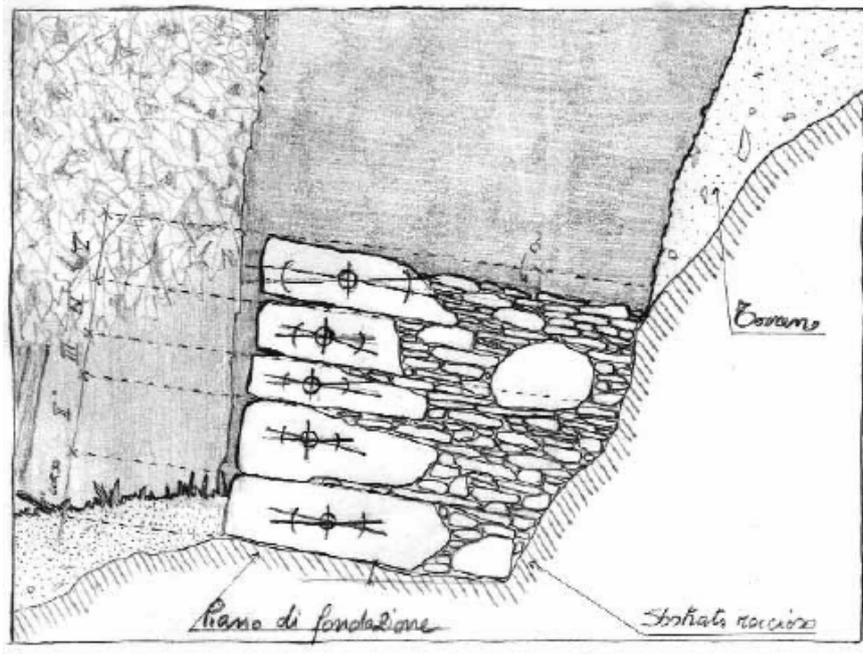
schema operativo di costruzione muretto a secco, particolare 1
